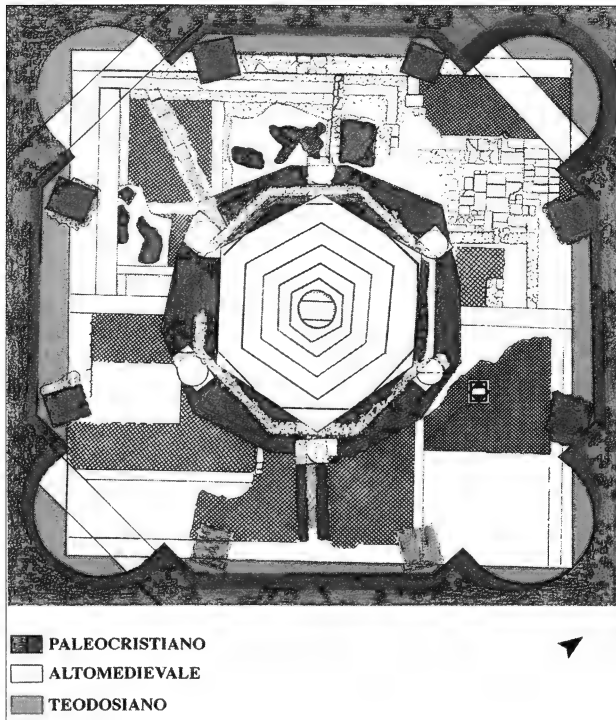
Battistero. Pianta (da LOPREATO 1989).
